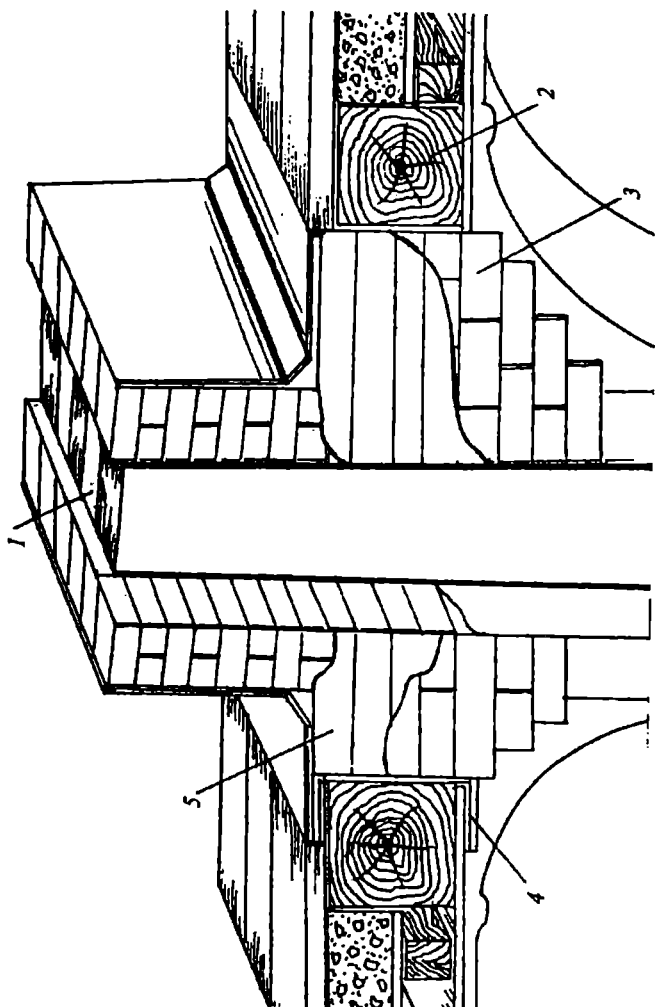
Разделка дымохода в междуэтажном деревянном перекрытии:
